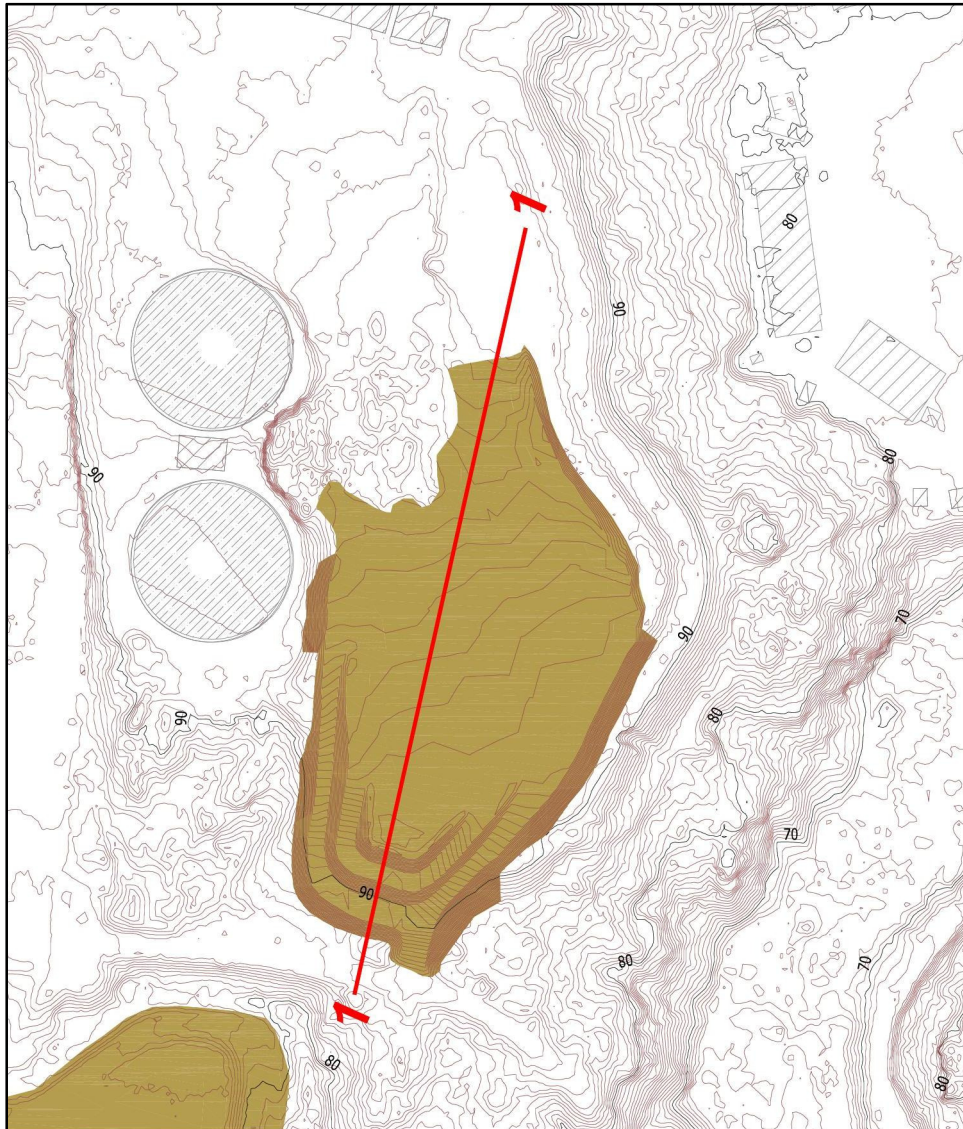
Cantiere Seruci – Argine Sud in progetto – Sez. 1-1
